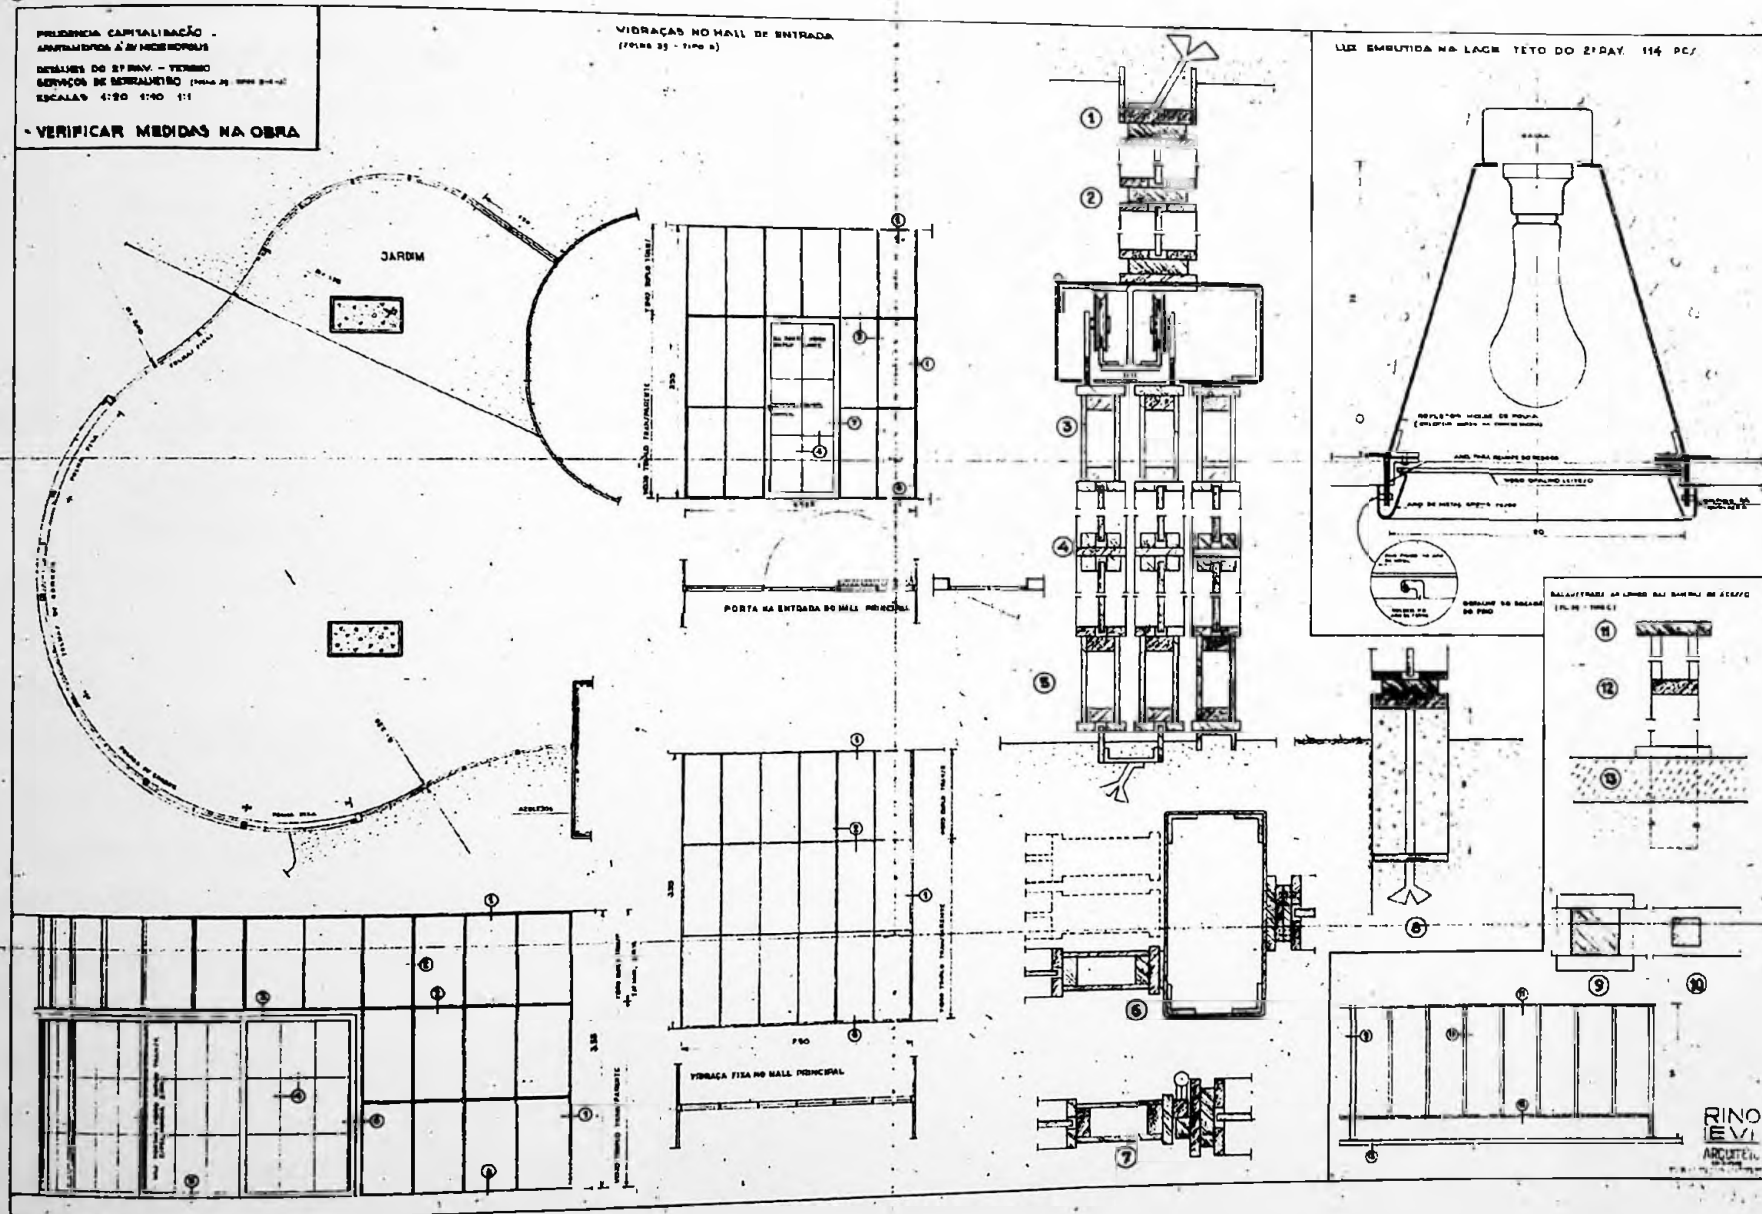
detalhes -serviços de serralheiro / 2º pavimento - térreo
